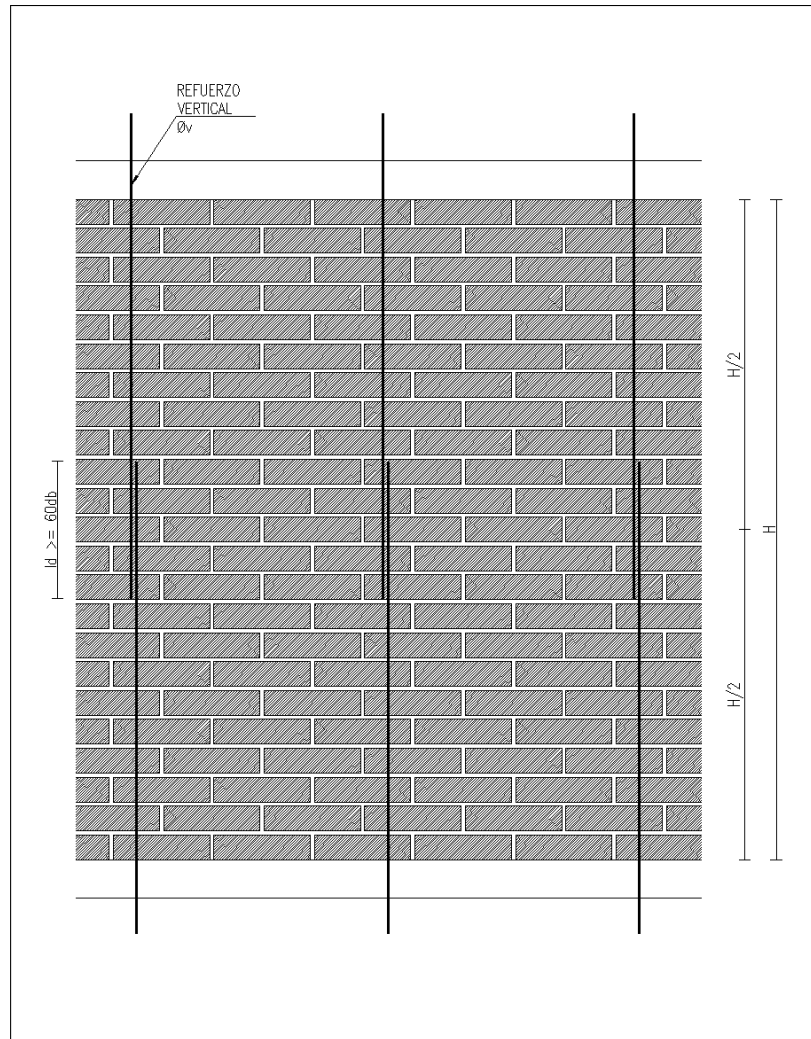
Detalle del empalme por traslape de las barras de refuerzo vertical.
